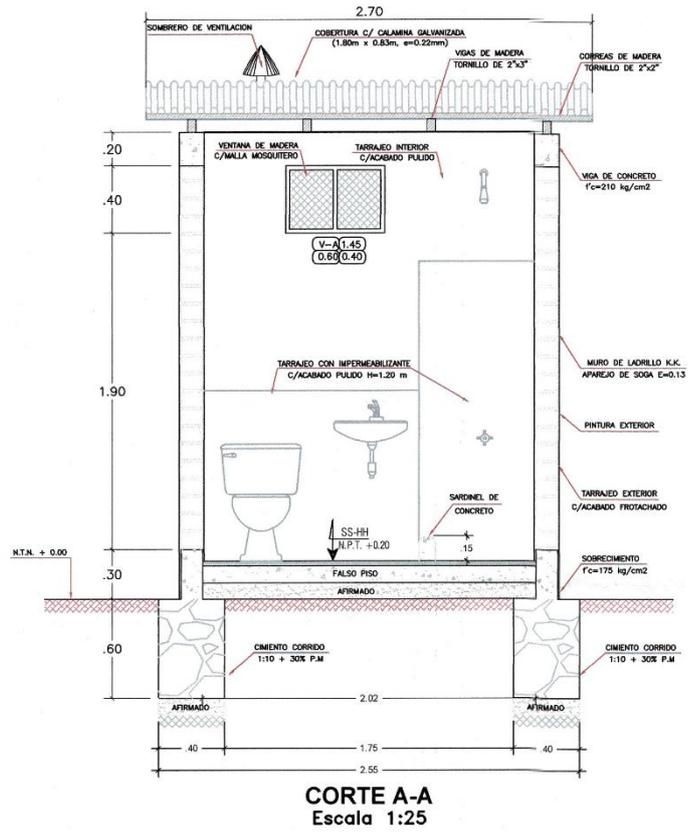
Planos de detalles de UBS tipo arrastre hidráulico
